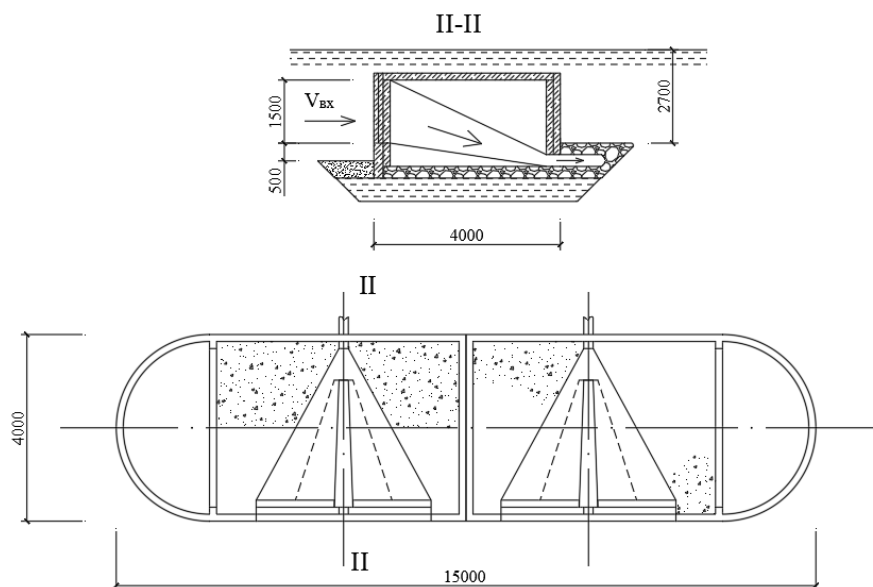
Залізобетонний розтрубний оголовок з боковим прийомом води
